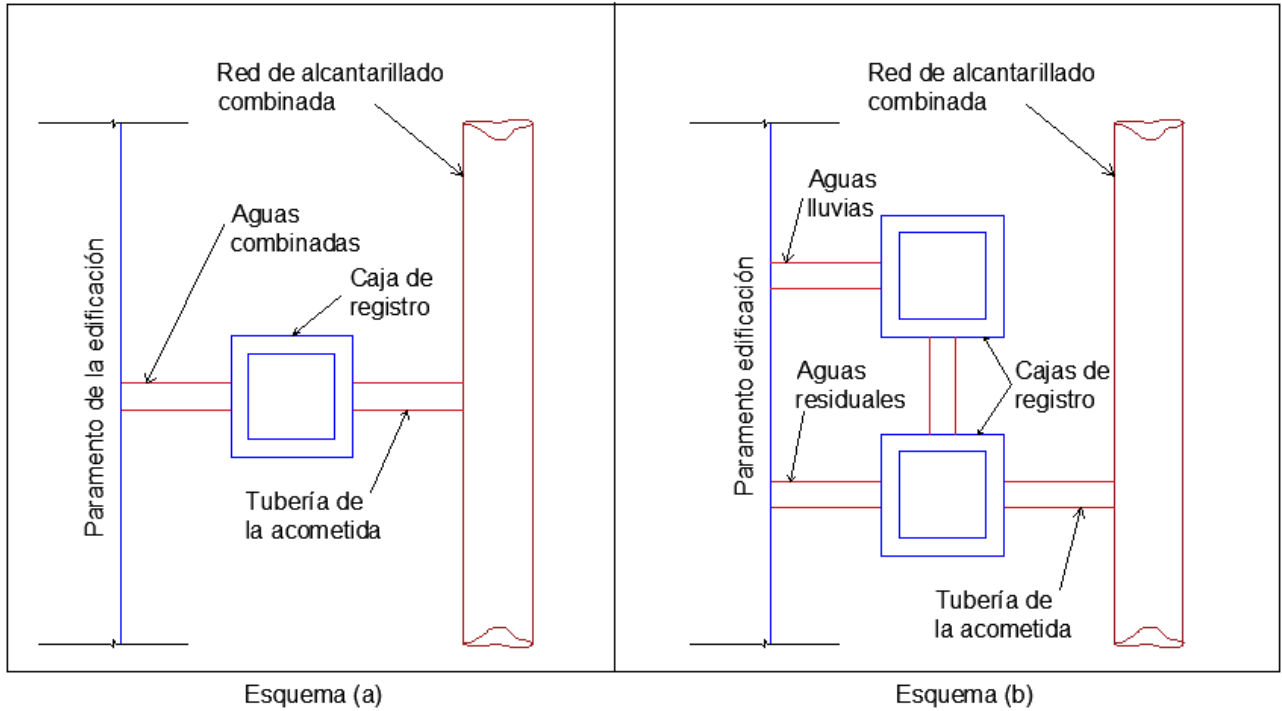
Conexión de acometidas a redes combinadas de alcantarillado (vista en planta)
